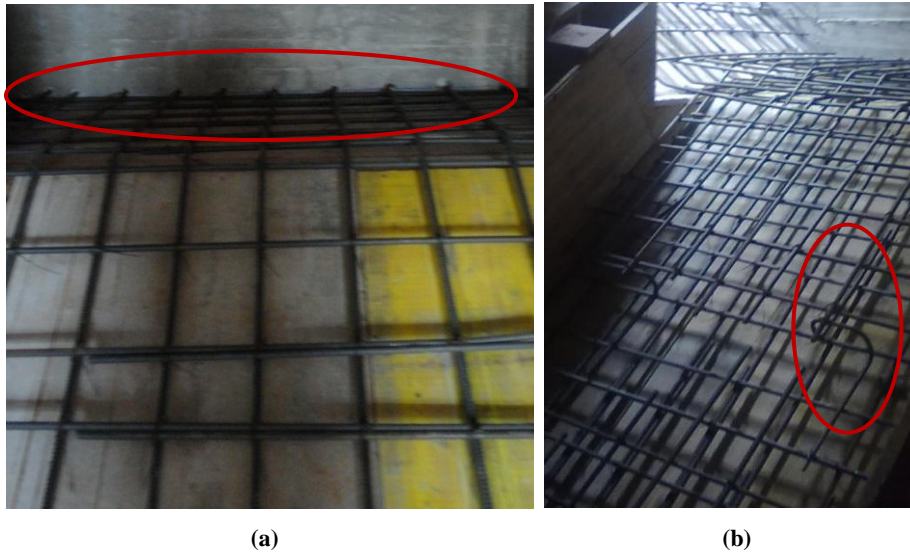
Fixação da armadura inferior à estrutura (a) e colocação de espaçador sob a malha superior (b)
